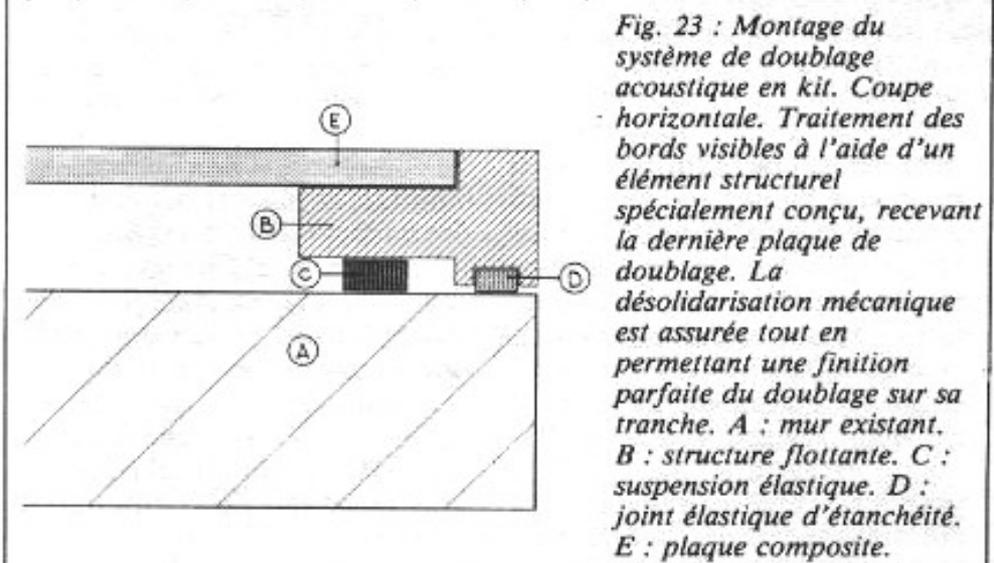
Montage du système de doublage acoustique en kit. Coupe horizontale. Traitement des bords visibles à l'aide d'un élément structurel spécialement conçu, recevant la dernière plaque de doublage. La désolidarisation mécanique est assurée tout en permettant une finition parfaite du doublage sur sa tranche. A : mur existant. B : structure flottante. C : suspension élastique. D : joint élastique d'étanchéité. E : plaque composite.
